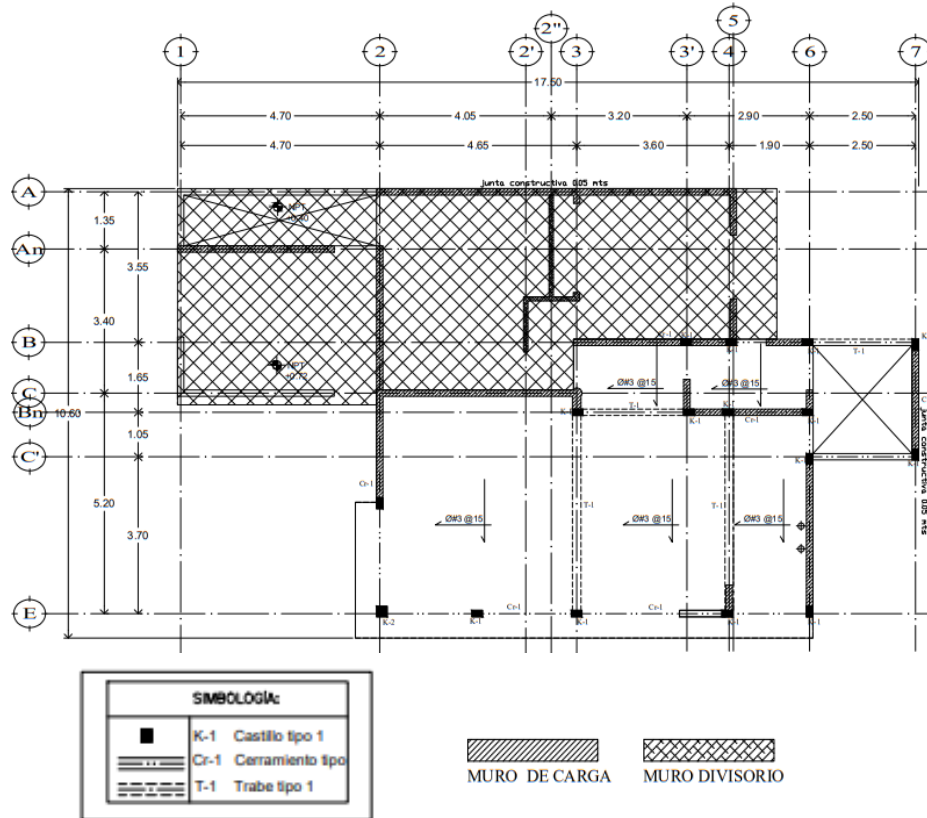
Propuesta estructural, caso Leticia Navarro Alfaro. Elaboración propia.
